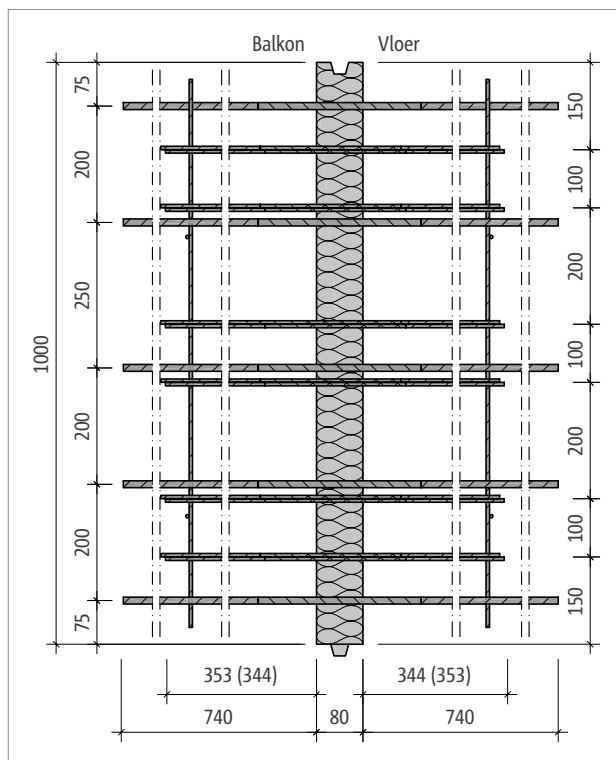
Schöck Isokorf® T type D bij CV30: Zijaanzicht
